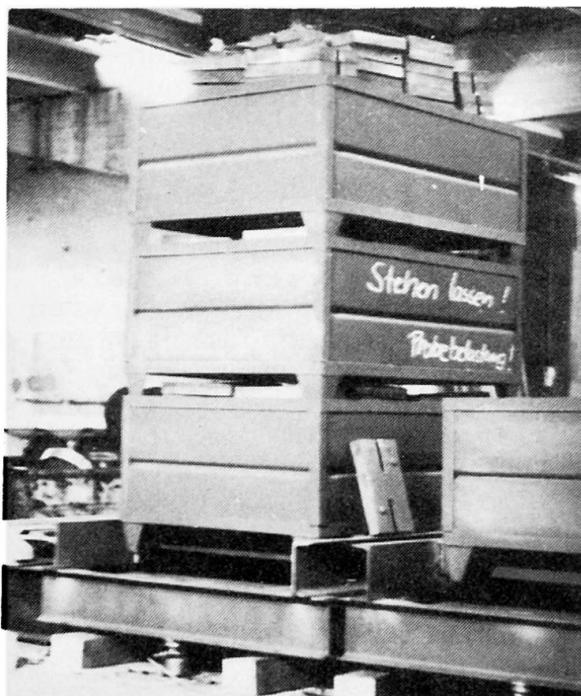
Belastung einer Kassettendeckenplatte in einem mehrgeschossigen Industriebau durch Einzellasten
